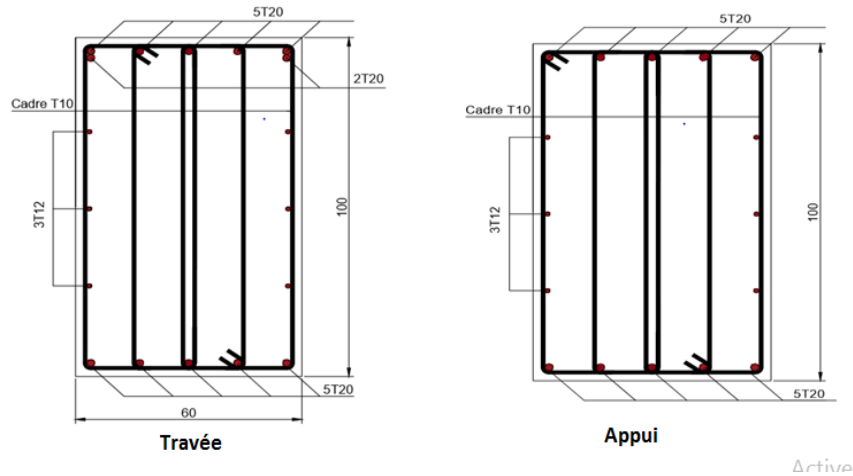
Schéma de ferrailage de la nervure de section (60\*100) dans le sens porteur
